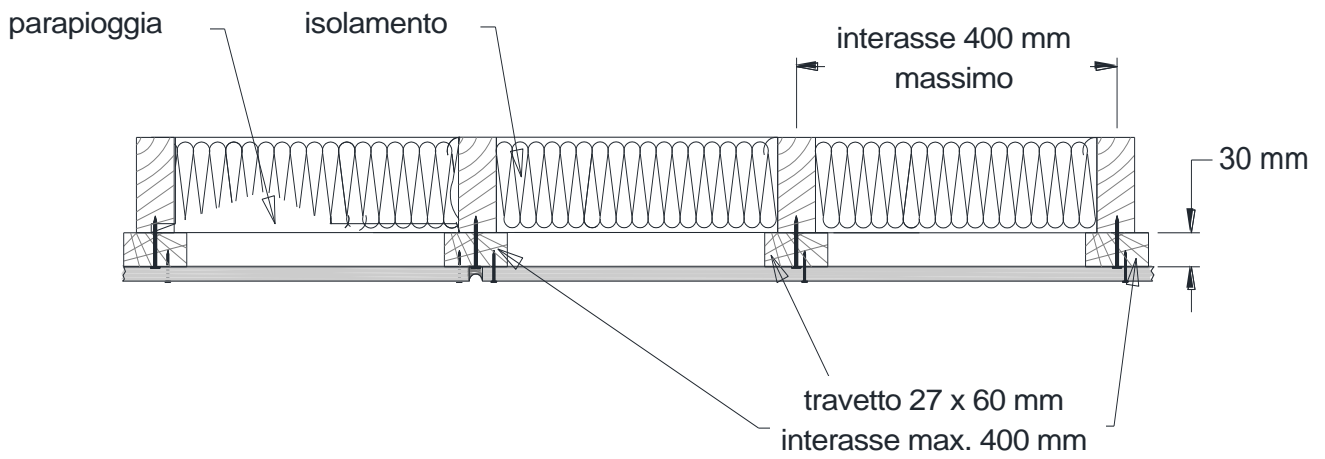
Sezione orizzontale su costruzione con struttura in legno – Posa orizzontale (interasse max. 400 mm)
